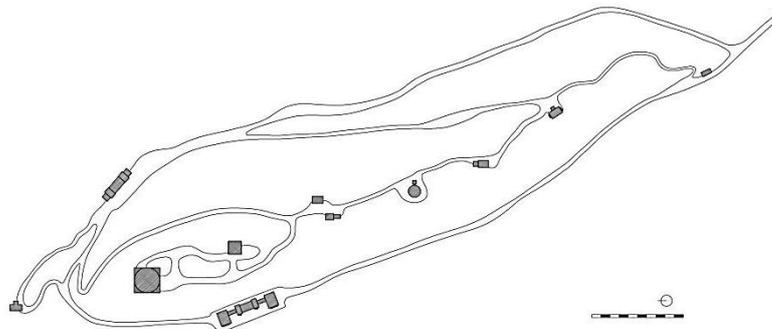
Observatorio de Niza. Planta de conjunto.
